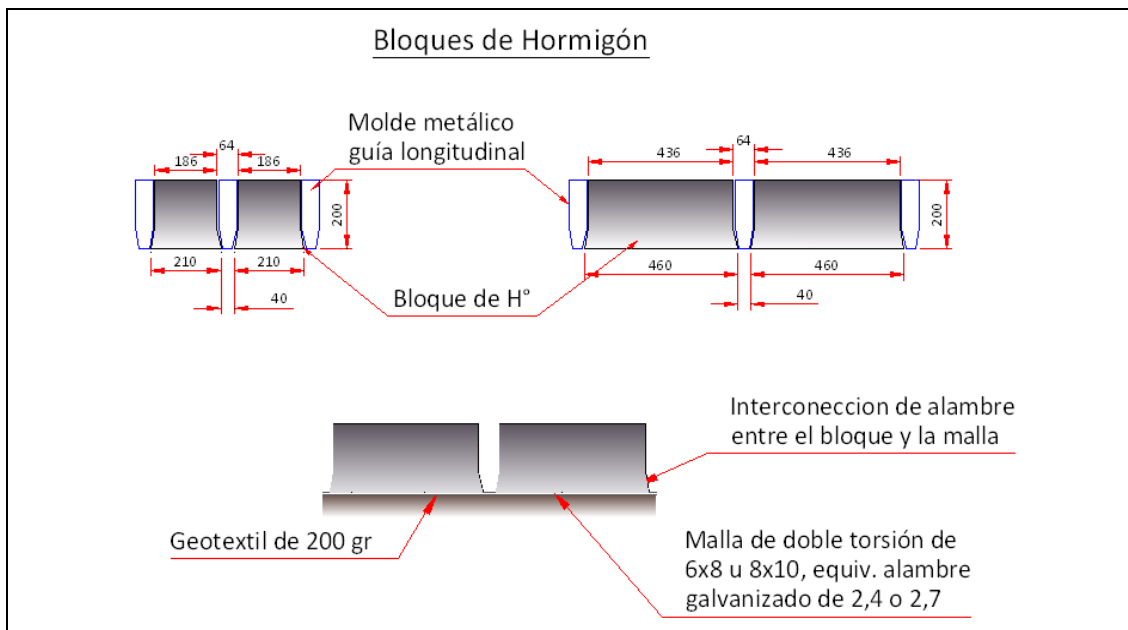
Detalles de los bloques de hormigón – Medidas en (mm).
